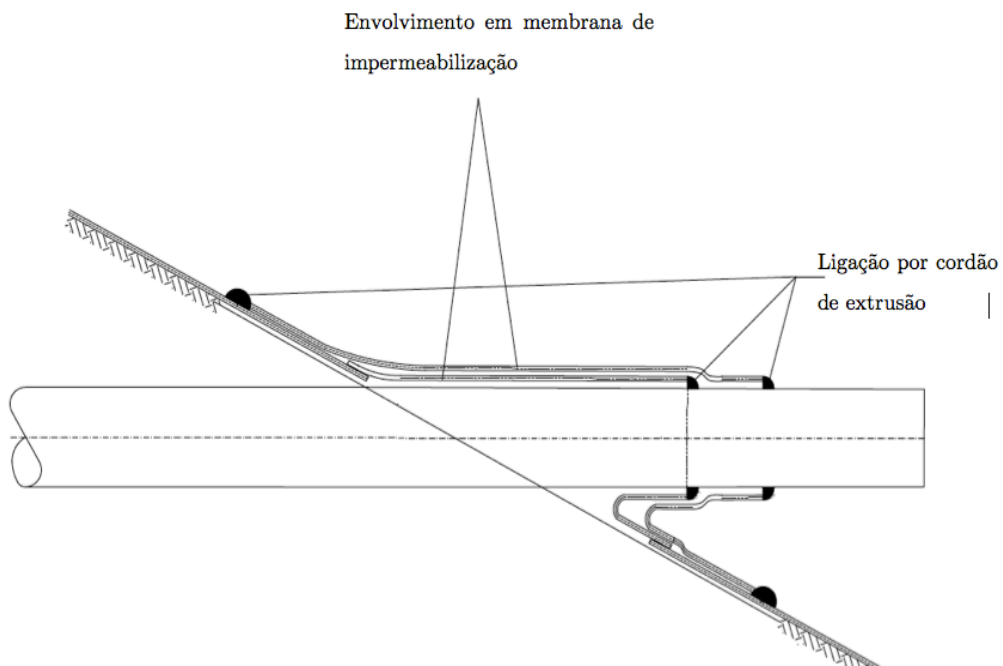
Pormenor de soldadura na intersecção da tubagem com sistema de impermeabilização, zona de talude.
